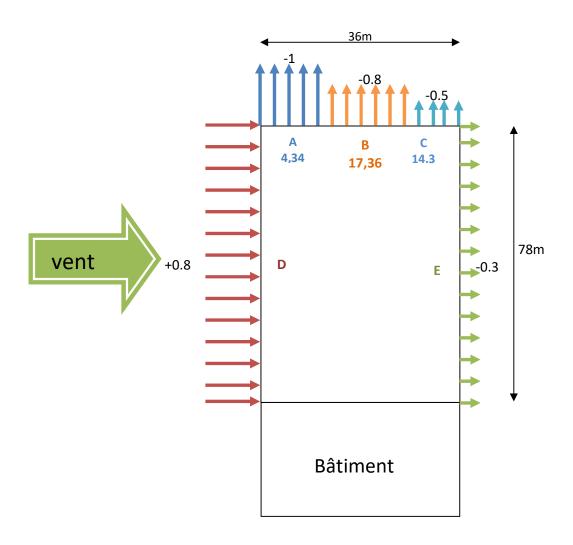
Cpe pour les parois verticales (Vent sur long-pan).
